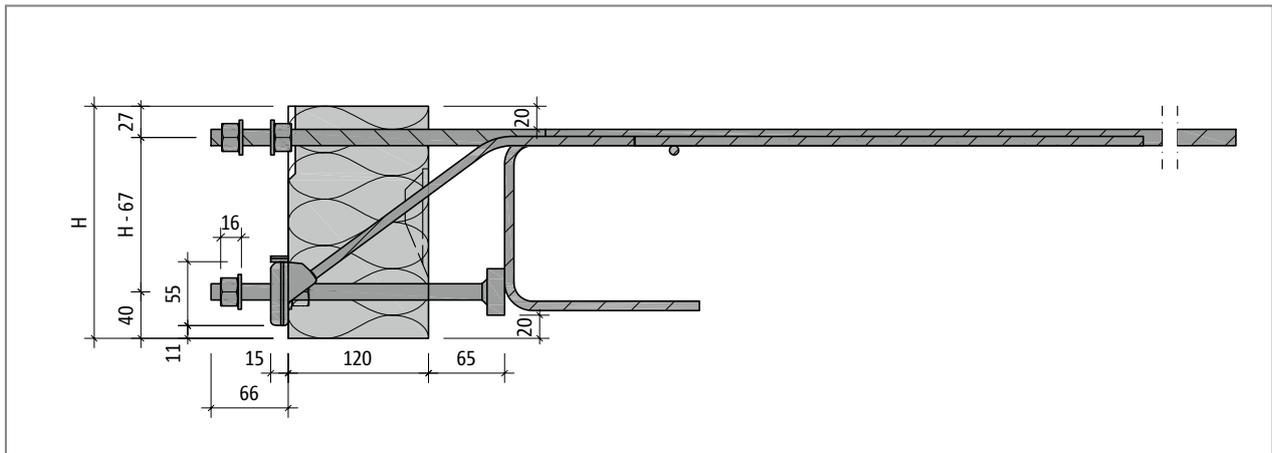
Schöck Isokorb® XT Typ SK-M1: Produktschnitt
